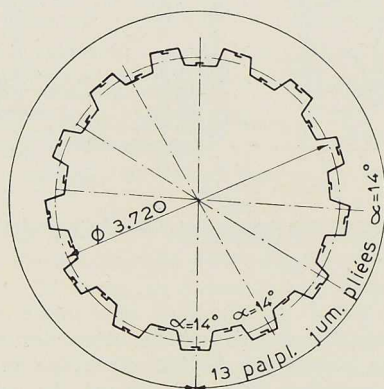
Schéma d'un duc d'Albe en poutre creuse de section circulaire en palplanches ondulées de profil normal.
